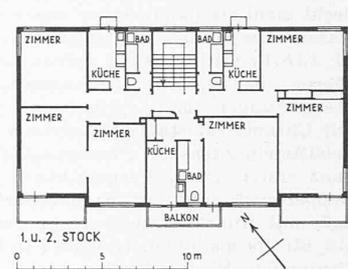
Haus Sprensbühlstrasse 2 Einzimmer-, Zweizimmer- und Dreizimmerwohnungen
